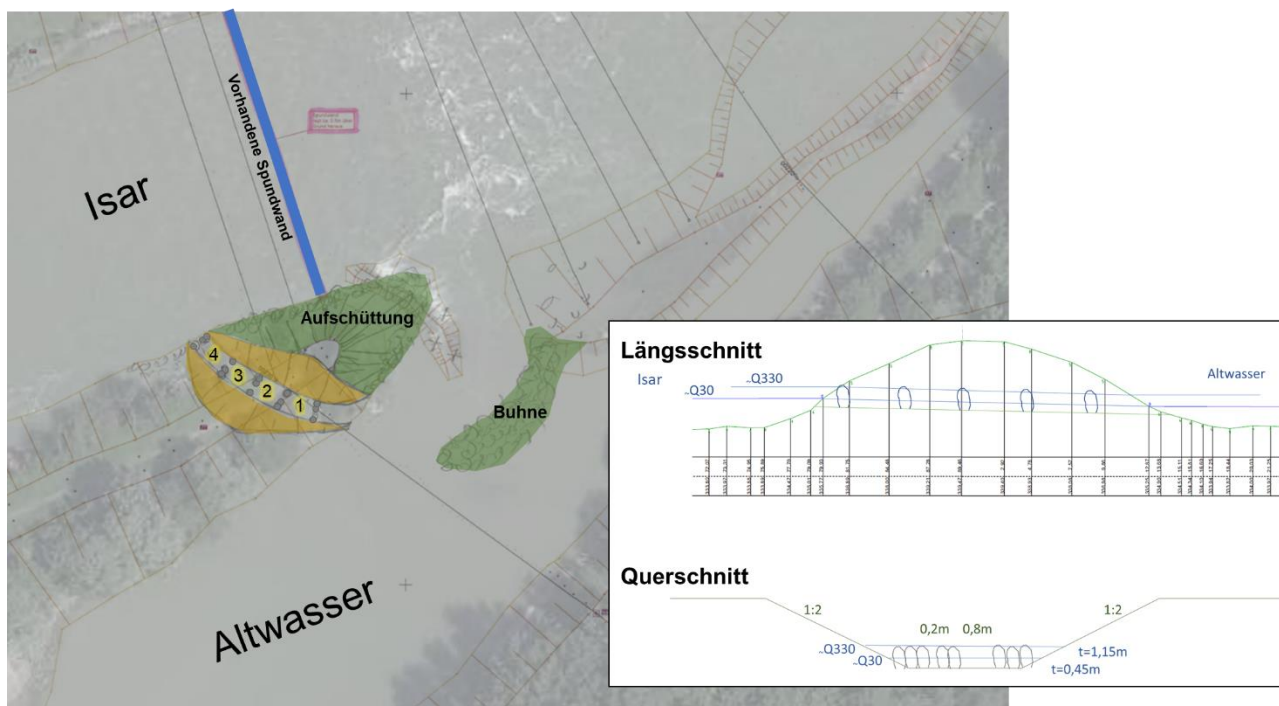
Übersichts-Lageplan der untersuchten Variante 6 aus dem Vorentwurf [10]
